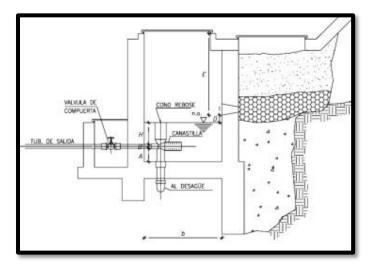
Captación de ladera. Fuente: Grupo Crixuz Ingeniería y Construcción. (2009)
